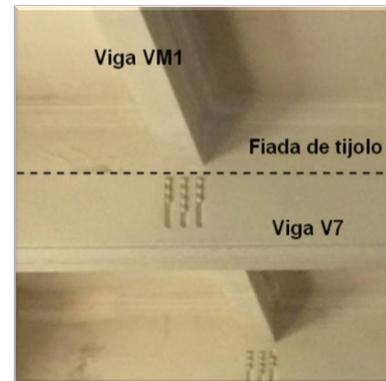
Materiais estruturais e processo construtivo: Pormenor A (2011).
